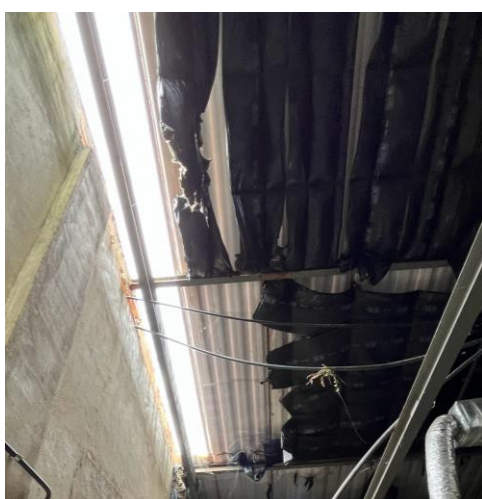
Trinca na alvenaria no local onde foi apoiada a estrutura metálica da cobertura
